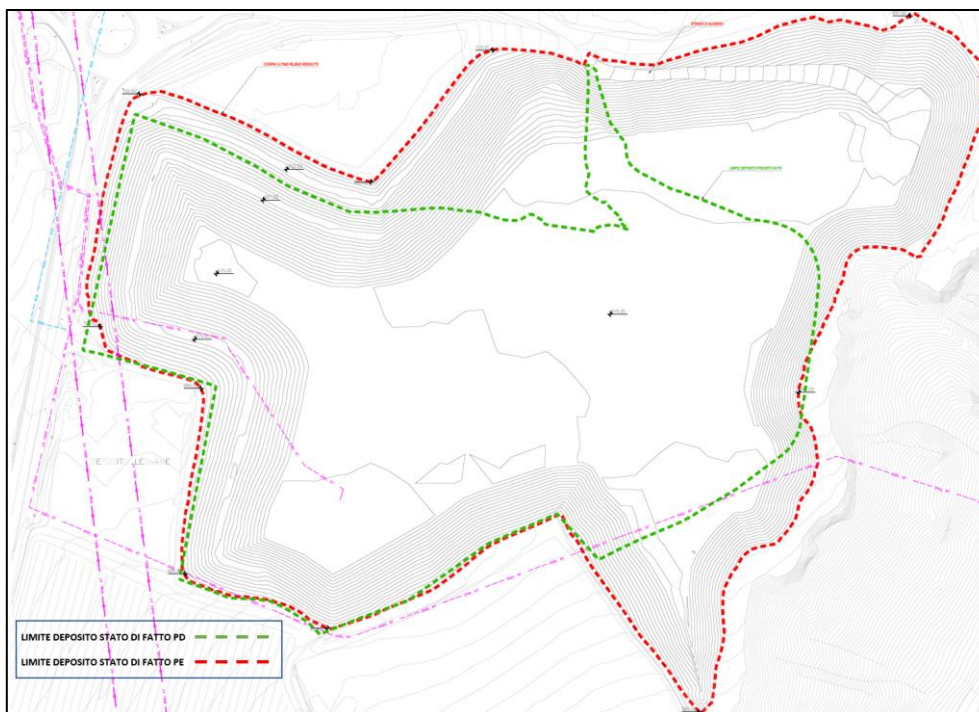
Planimetria Stato di fatto con confronto PD-PE – Forch I
